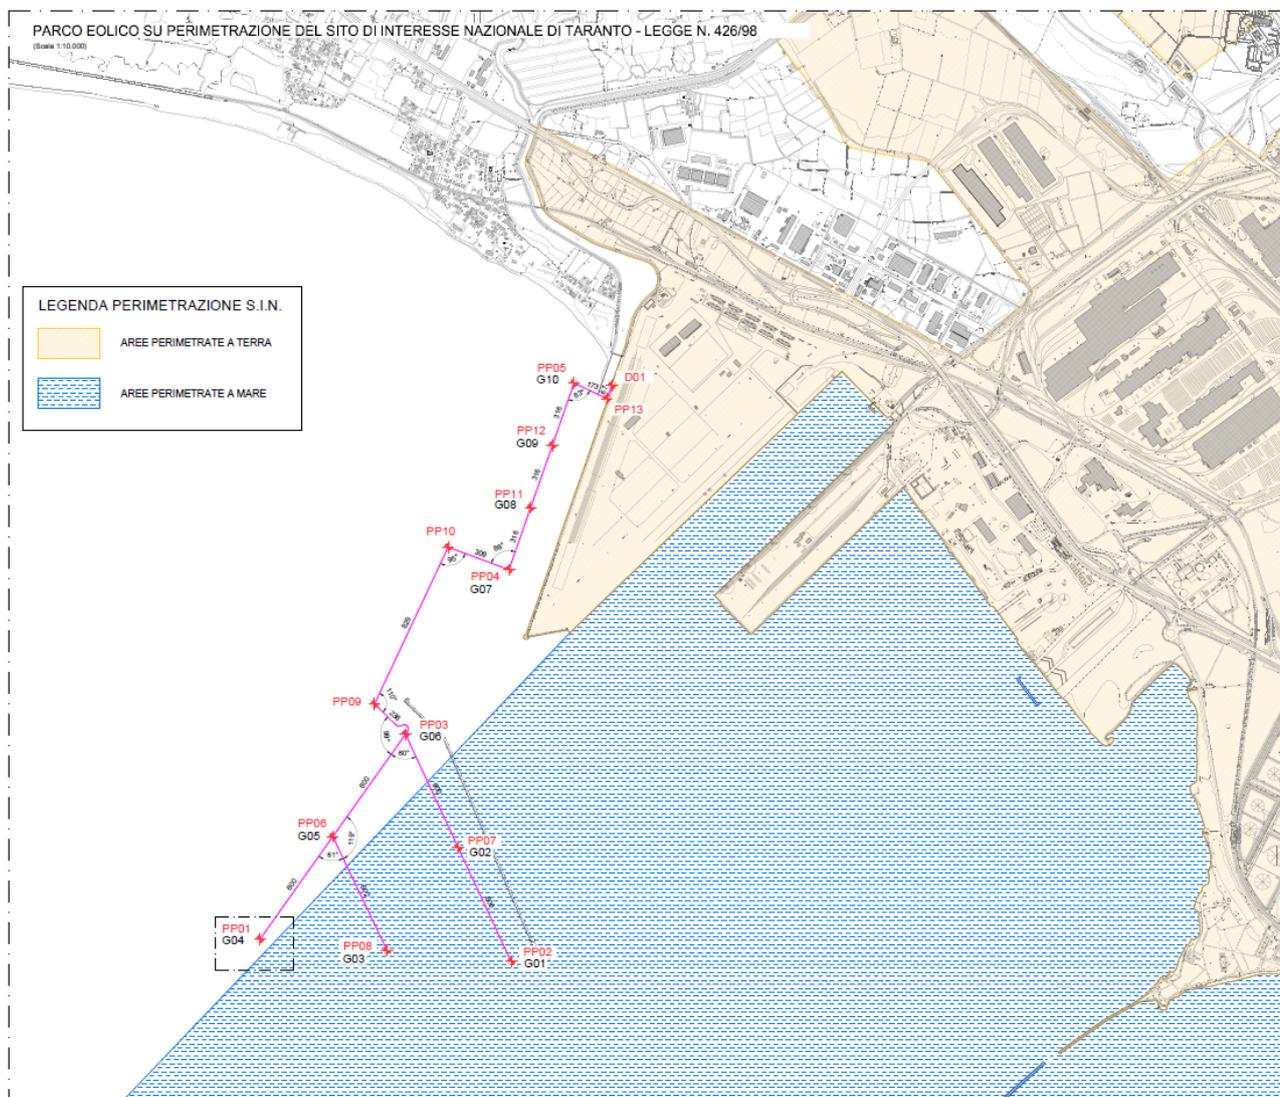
Pianta chiave – Layout impianto su aree S.I.N.
